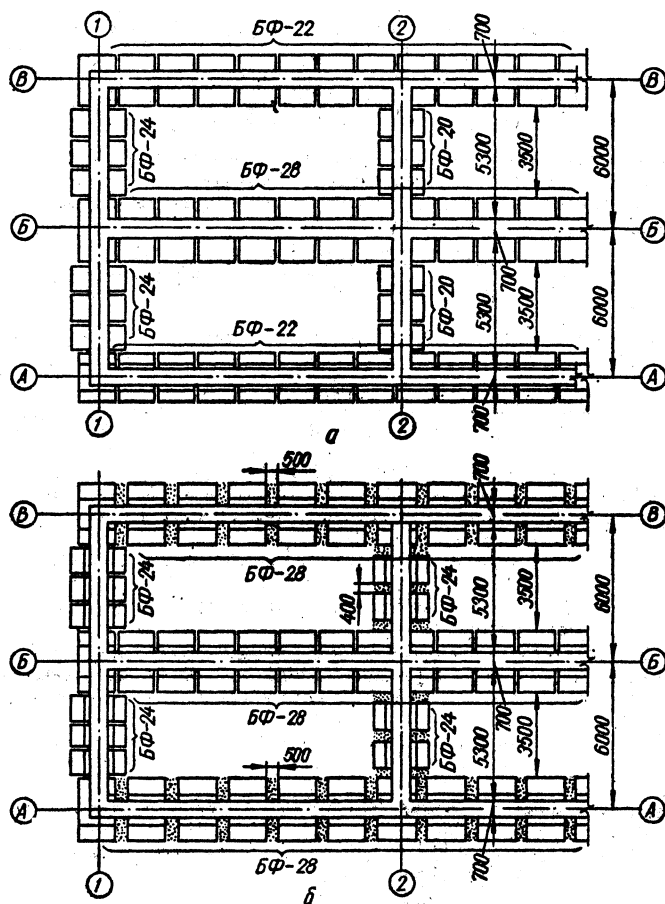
Сборный железобетонный ленточный фундамент:
